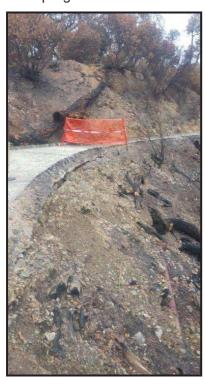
il tratto di strada interessato dal dissesto e i danni arrecati dall'incendio.
